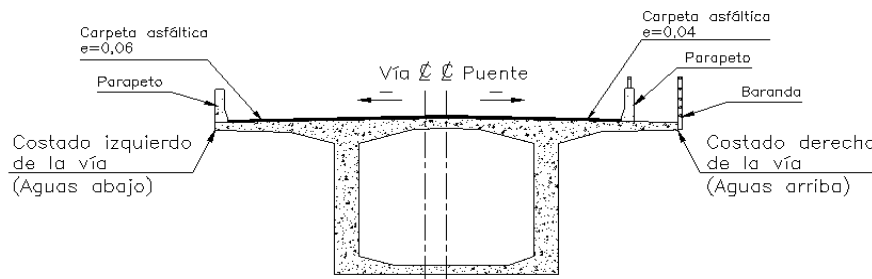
Cargas Permanentes en Sección Transversal Dovela Típica
